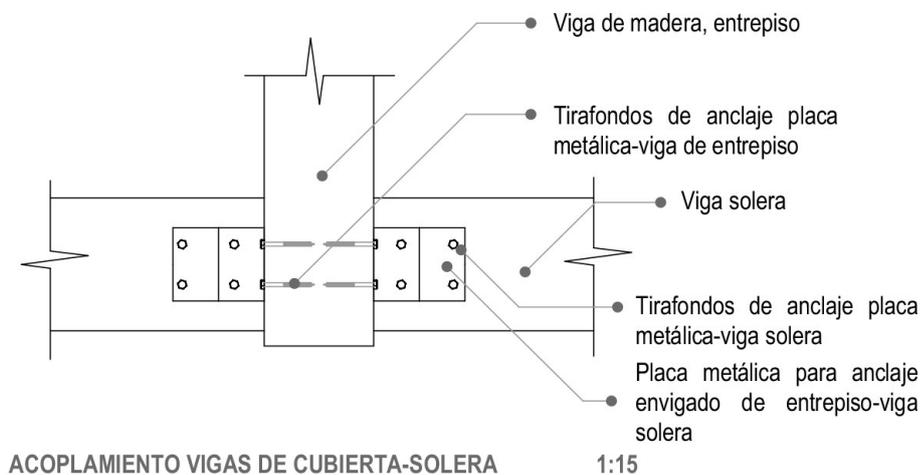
Detalle D9: Acoplamiento viga de cubierta-solera
